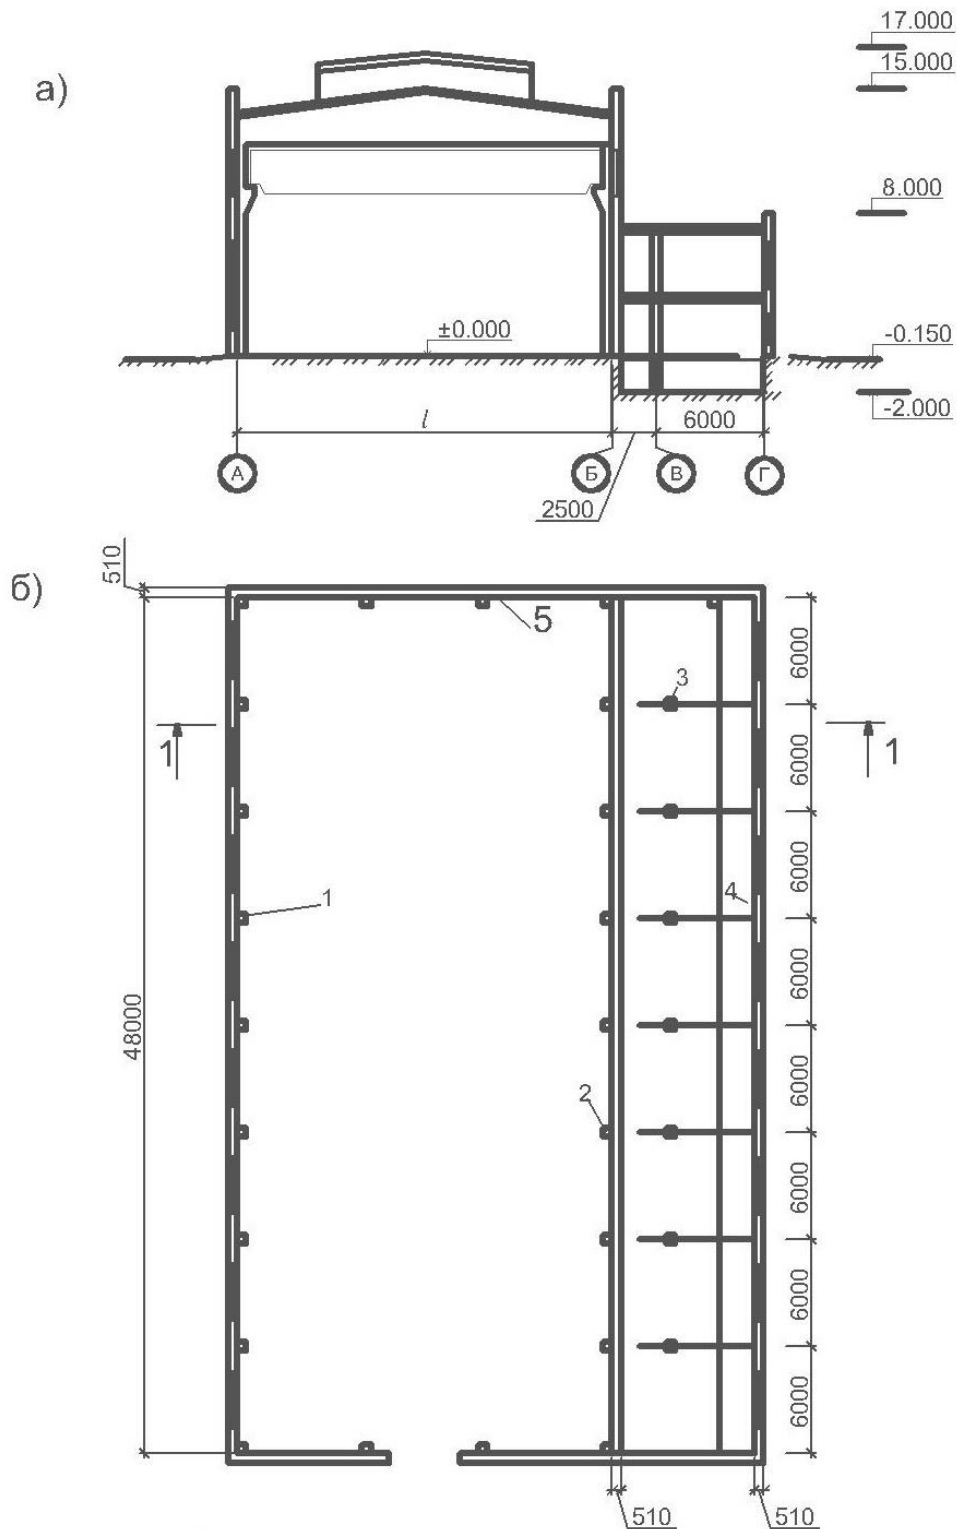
Схема здания сварочного цеха М 1:400
